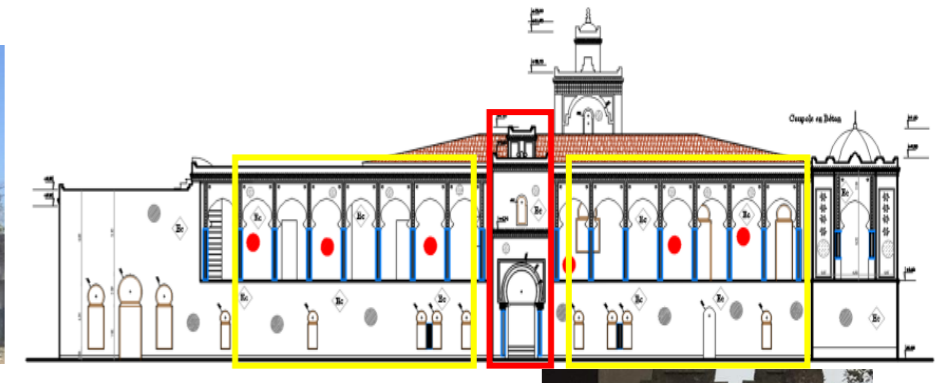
Façade Est. Source : BET Handassa wa Bina.
